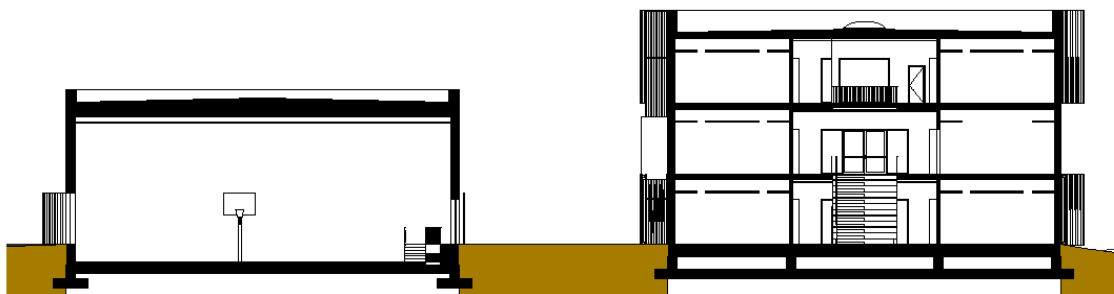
Sezione su palestra e auditorium: stato di progetto
